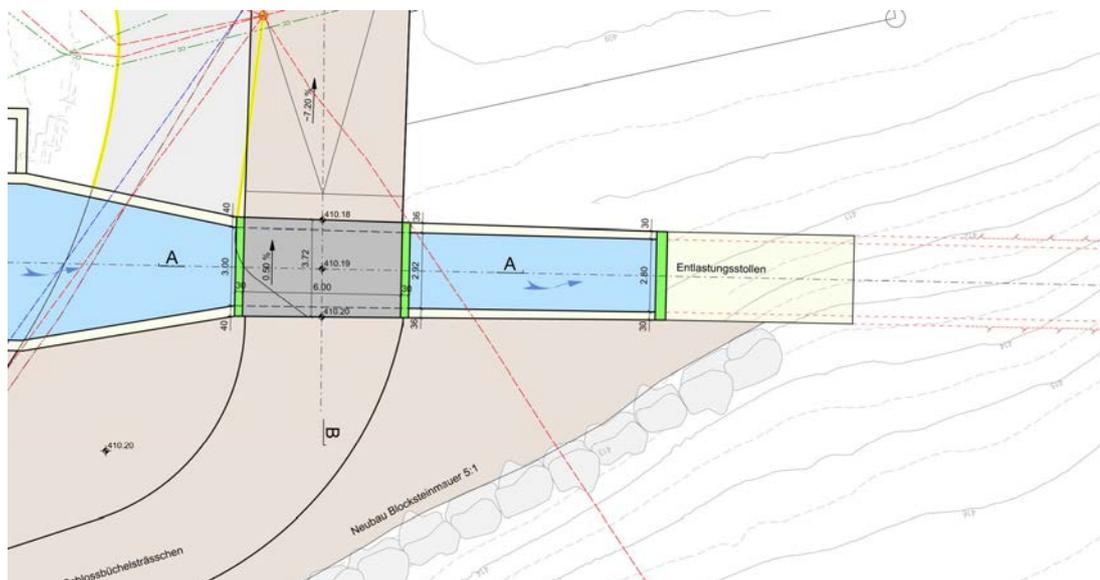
Horizontale Linienführung der Brücke Schlossbüchelsträsschen, Entlastungskanal
